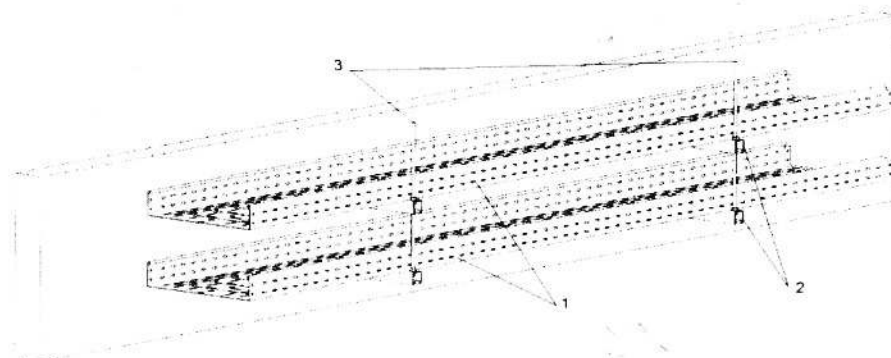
Общий вид подвеса к стене со шпилькой к потолку (таблица 42).
